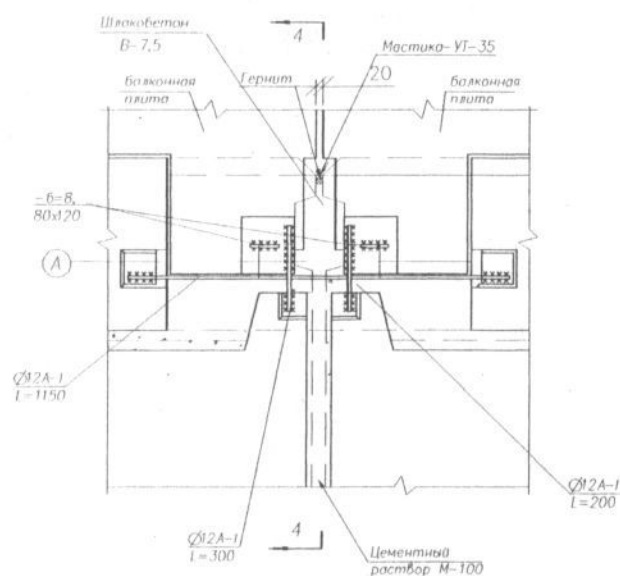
Угловой стык наружных панелей балконной плиты и панелей перекрытия
